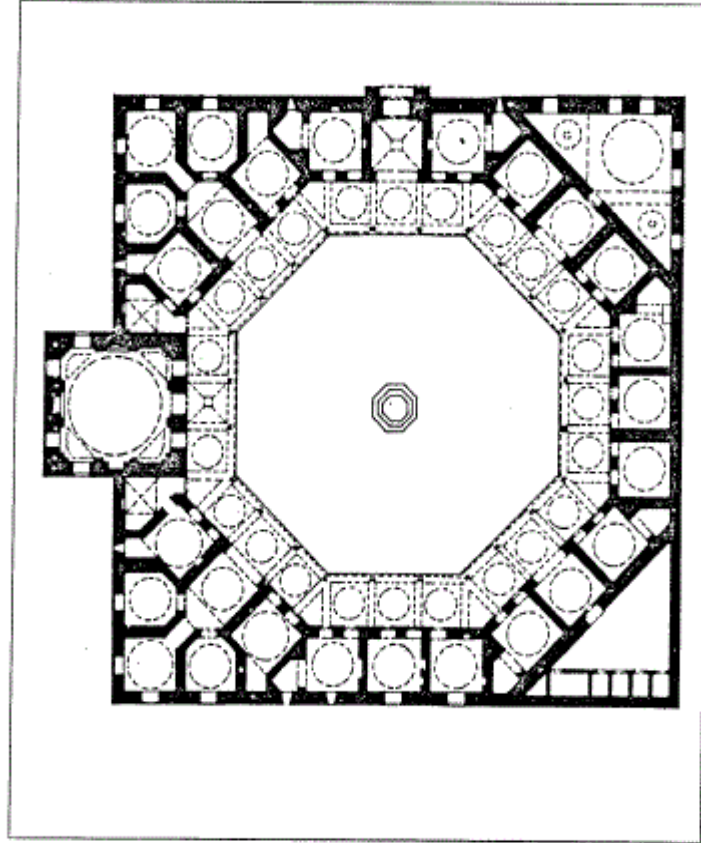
مسقط أفقي لمدرسة غازي خسرو بك في سراييفو (عن: إيفردي).
